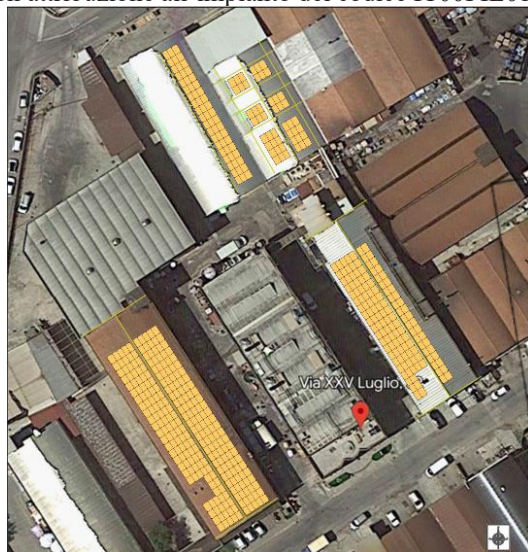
Foto aerea stabilimento con lay-out coperture fotovoltaiche
